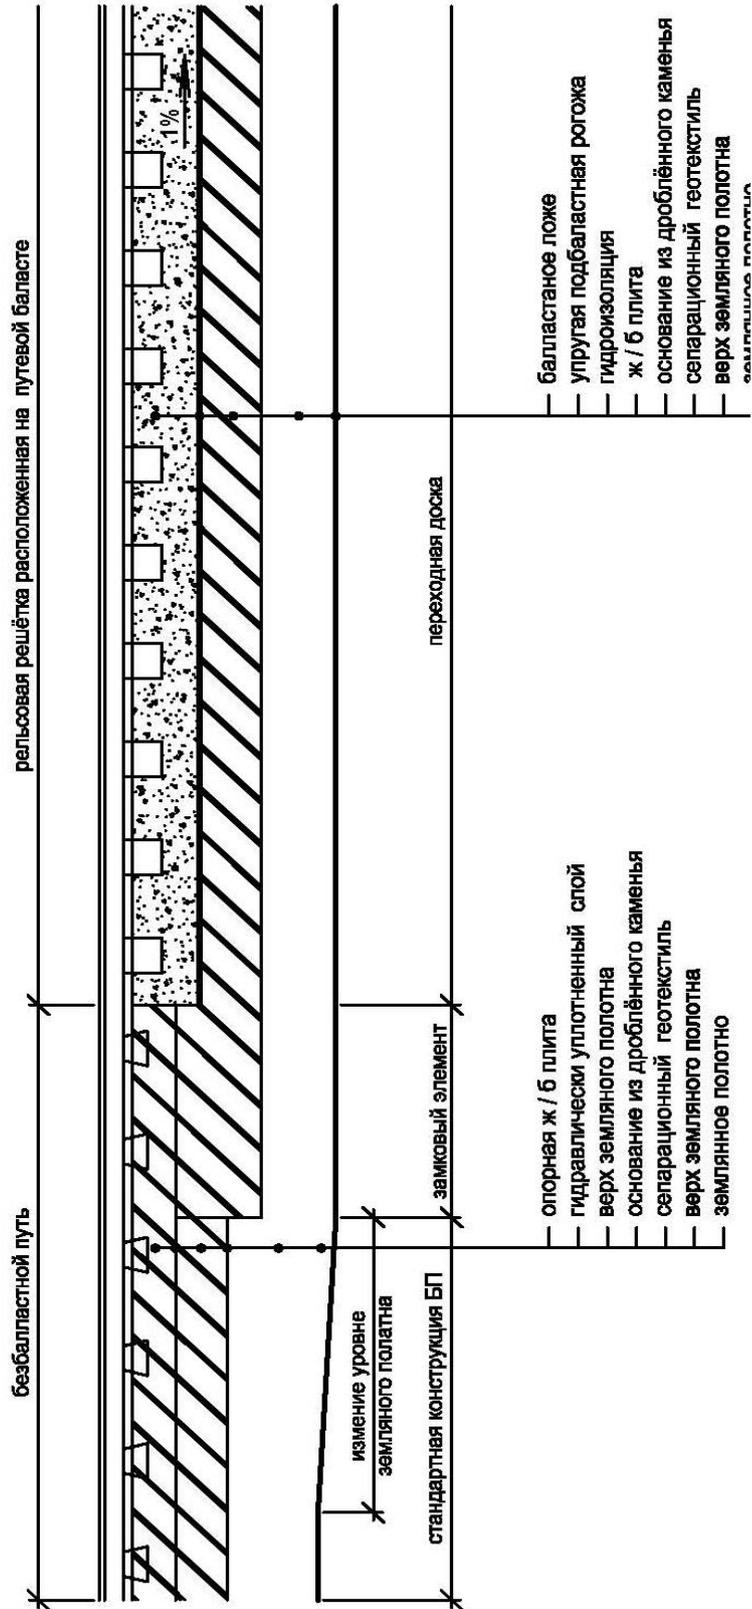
Пример решения перехода БП на путь с безбалластным ложем с помощью железобетонной ванны
